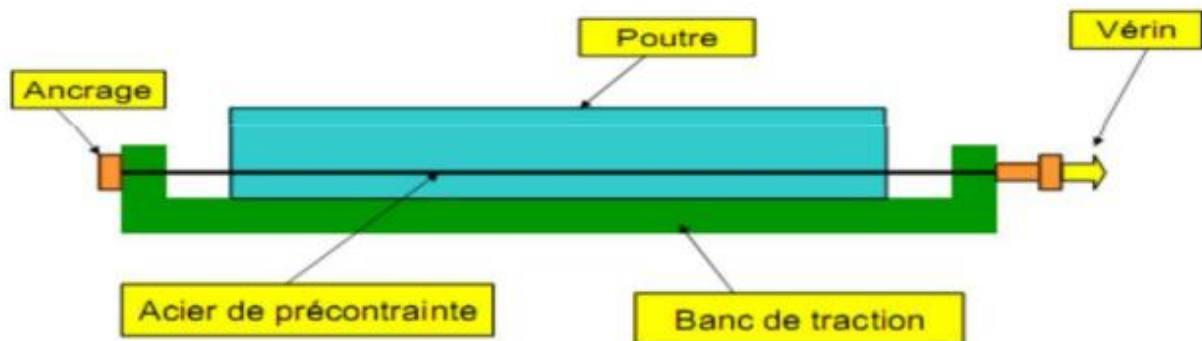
Coupe longitudinale d'une poutre en béton précontraint par pré-tension
